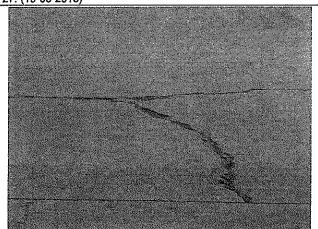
Fisuras y grietas con sellos deteriorados, cercano a kilómetro 8,9, camino rol G-27. (19-08-2013)
